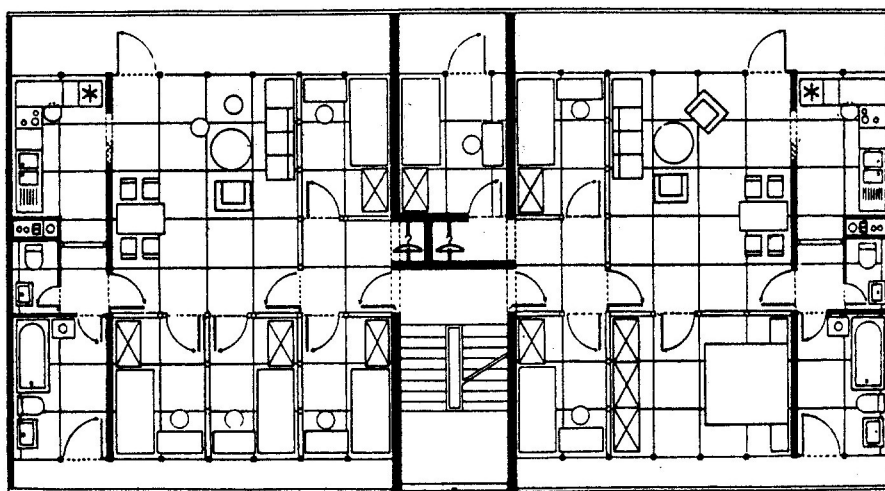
Planta de pavimento-tipo com estrutura de vãos livres e orientação modular, uma característica típica nos projetos alemães (Fonte: TRIEBEL, 1980)
